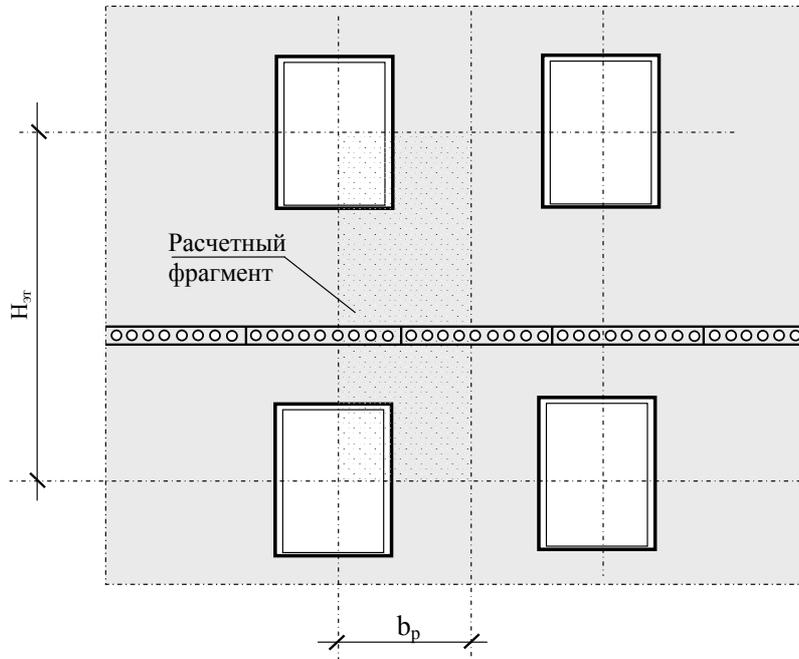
Расчетный фрагмент наружной стены здания для определения приведенного сопротивления теплопередаче участка с оконными проемами (вид со стороны помещения)
